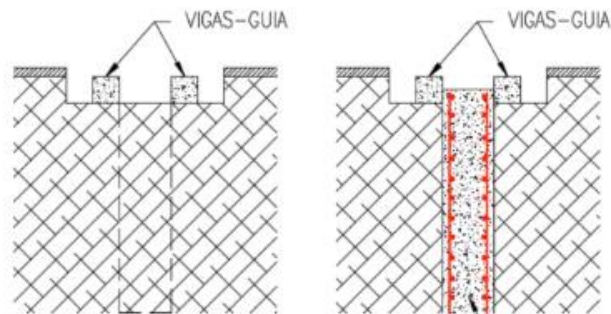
Excavación, instalación de refuerzos y vertimiento de concreto
